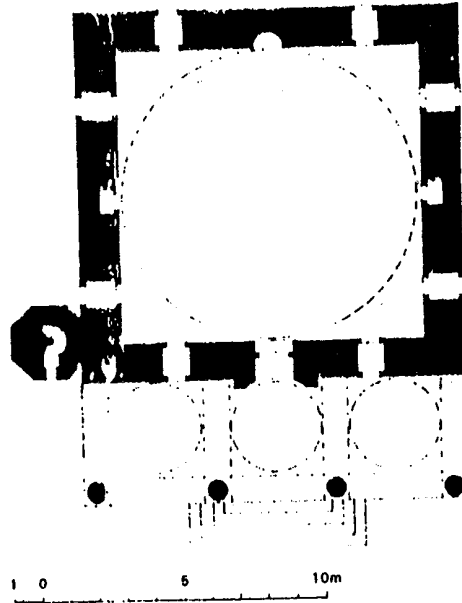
مسقط أفقي لمسجد صرجالي بقونية (عن : Aslanapa)
